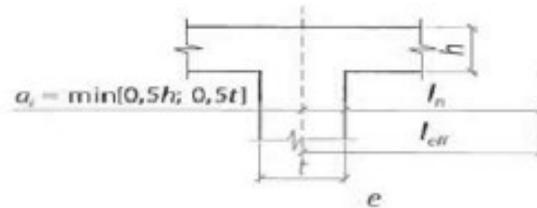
Определение расчетного пролета конструкций по СП РК EN «Бетонные и железобетонные конструкции»
